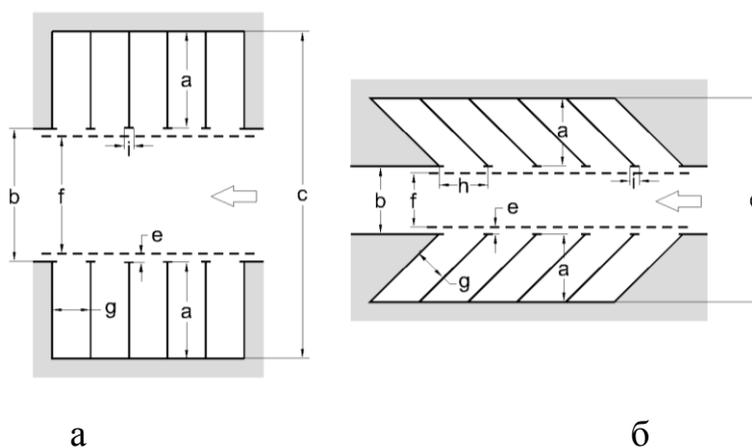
Схема разбивки парковочных мест двухсторонней
